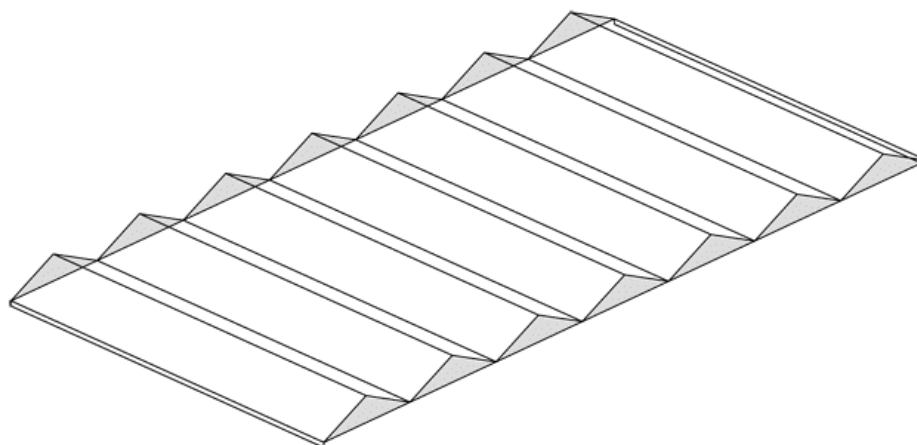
Configuração em série de lâminas plissadas com vigas de bordo extremas.
